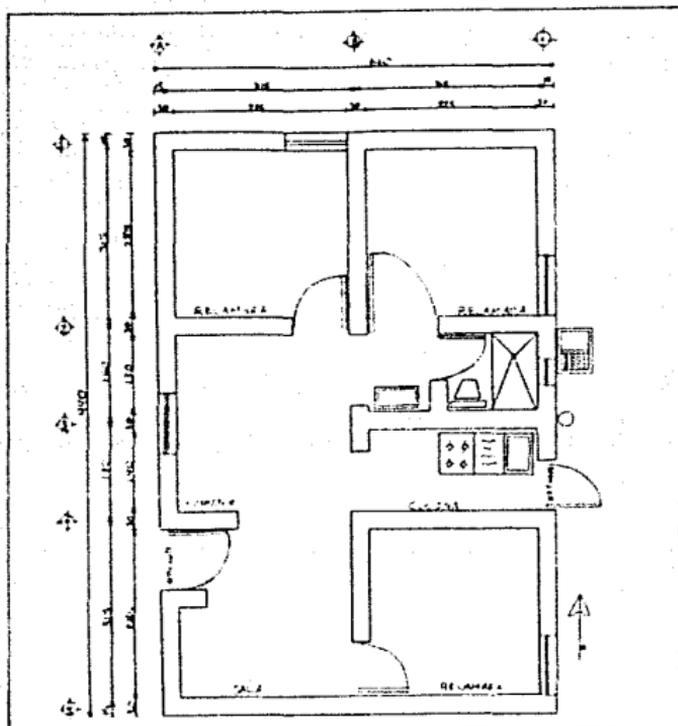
Planta arquitectónica para la vivienda de adobe normal.
